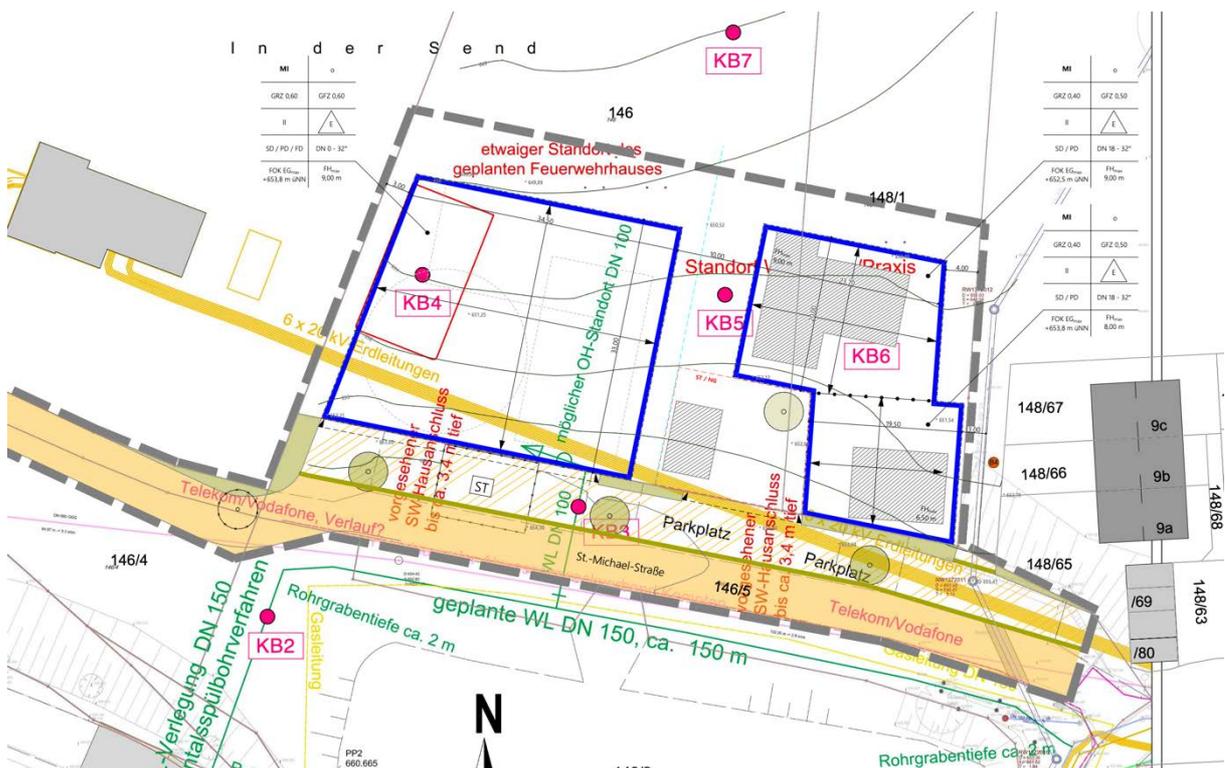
Überlagerung Leitungsplan mit Vorentwurf Bauungsplan
